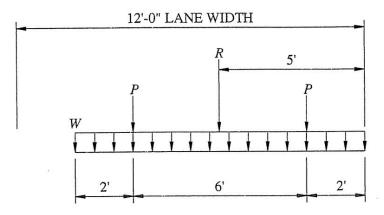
Posición de carga viva HL-93 dentro de un carril
